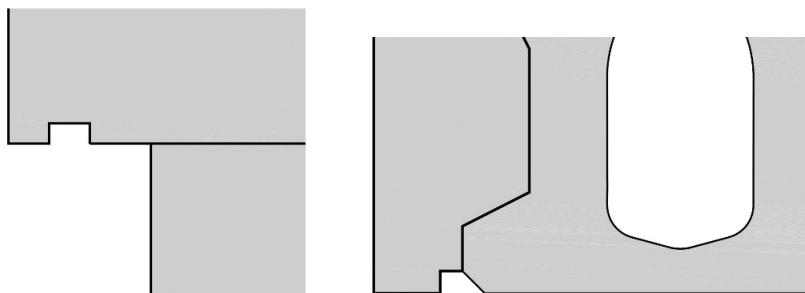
, izquierda goterón colado en el pretil de hormigón, derecha goterón conformado en la junta con la losa hueca
